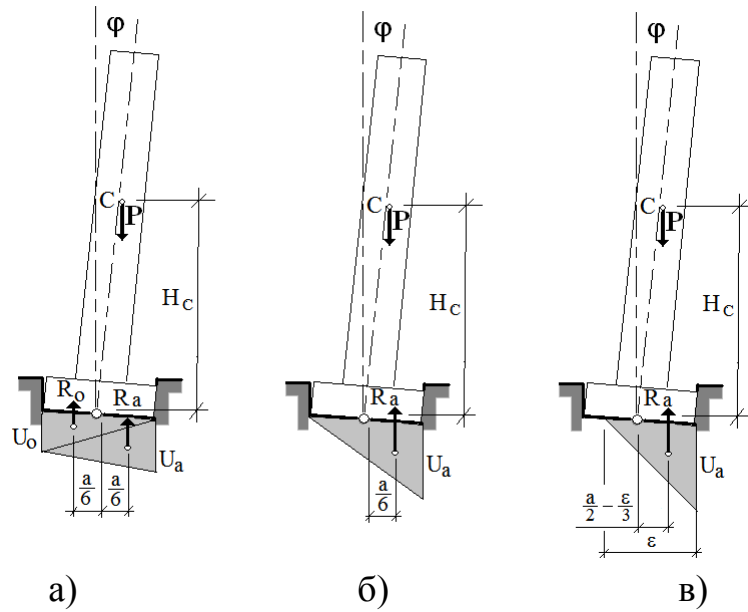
Схемы контакта фундаментной плиты с несущим слоем основания
